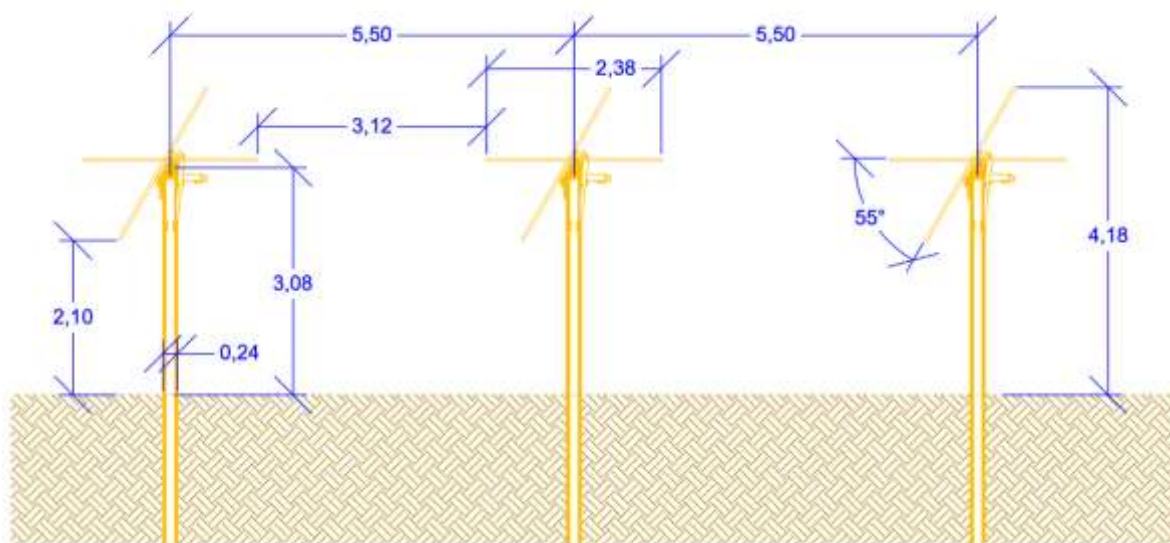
Vista delle strutture fotovoltaiche in sezione previste per il progetto
